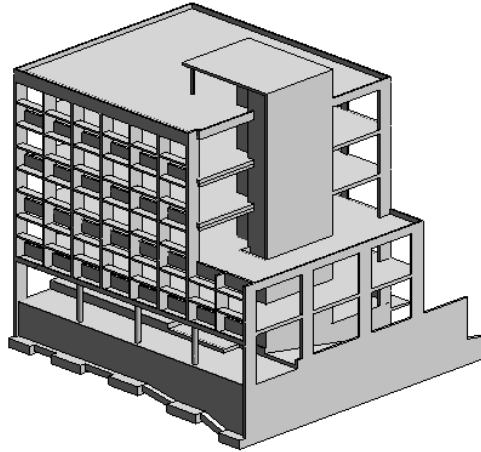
Projeto de estruturas de um edifício em BIM.
